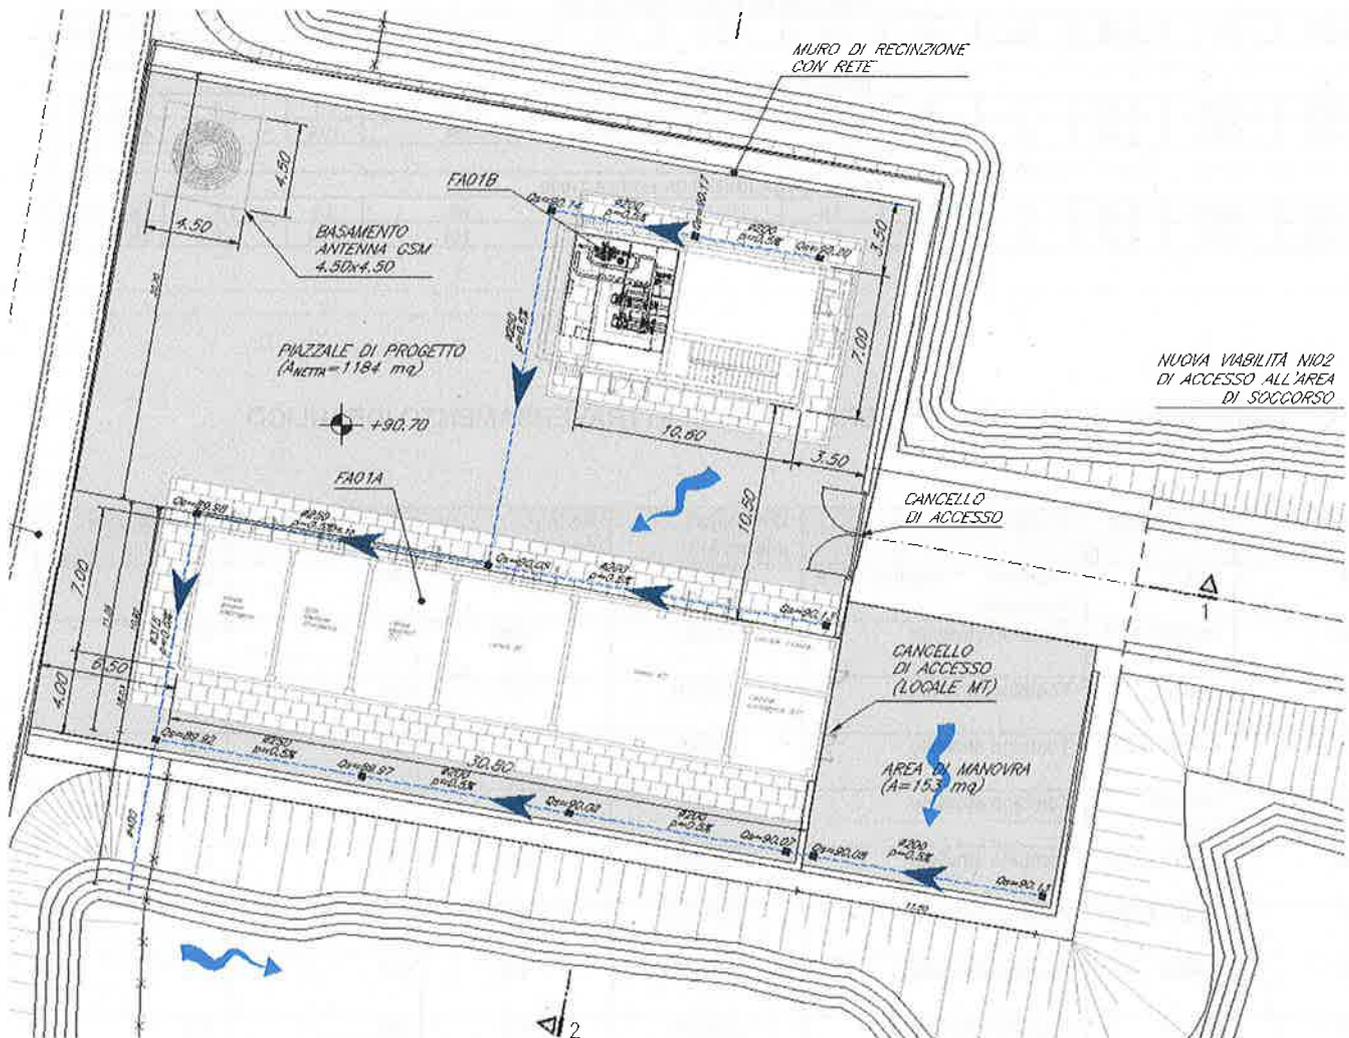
PLANIMETRIA PIAZZALE RI51
